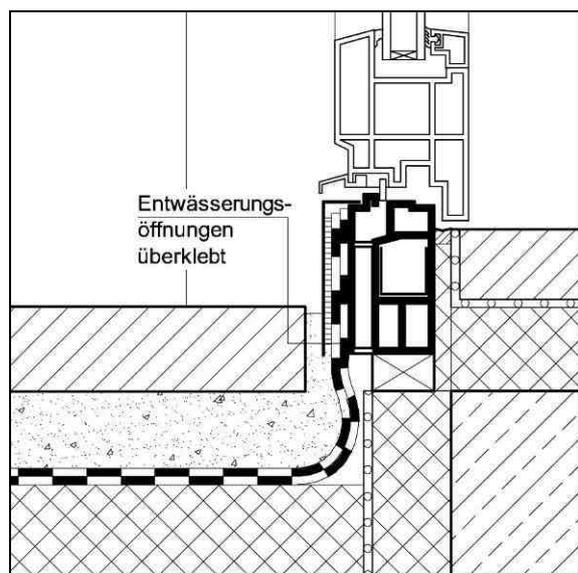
Detail mangelhafter Terrassentüranschluss
